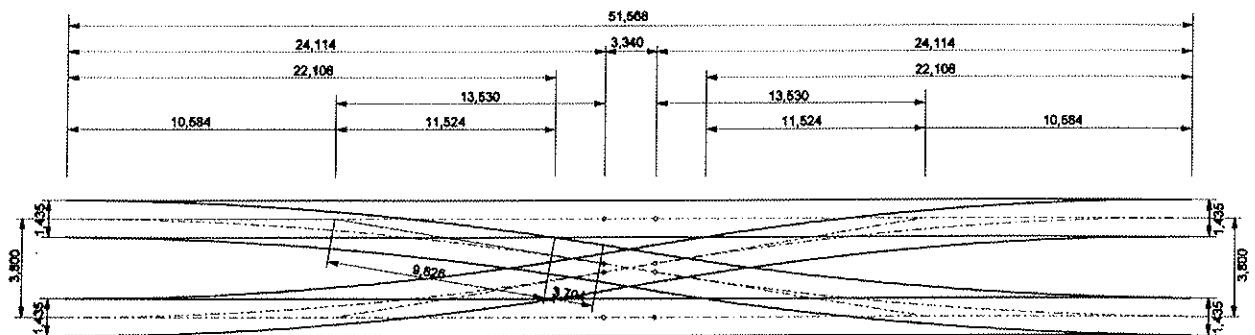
Esquema de bretelle de tangente 1/8 para las zonas terminales
